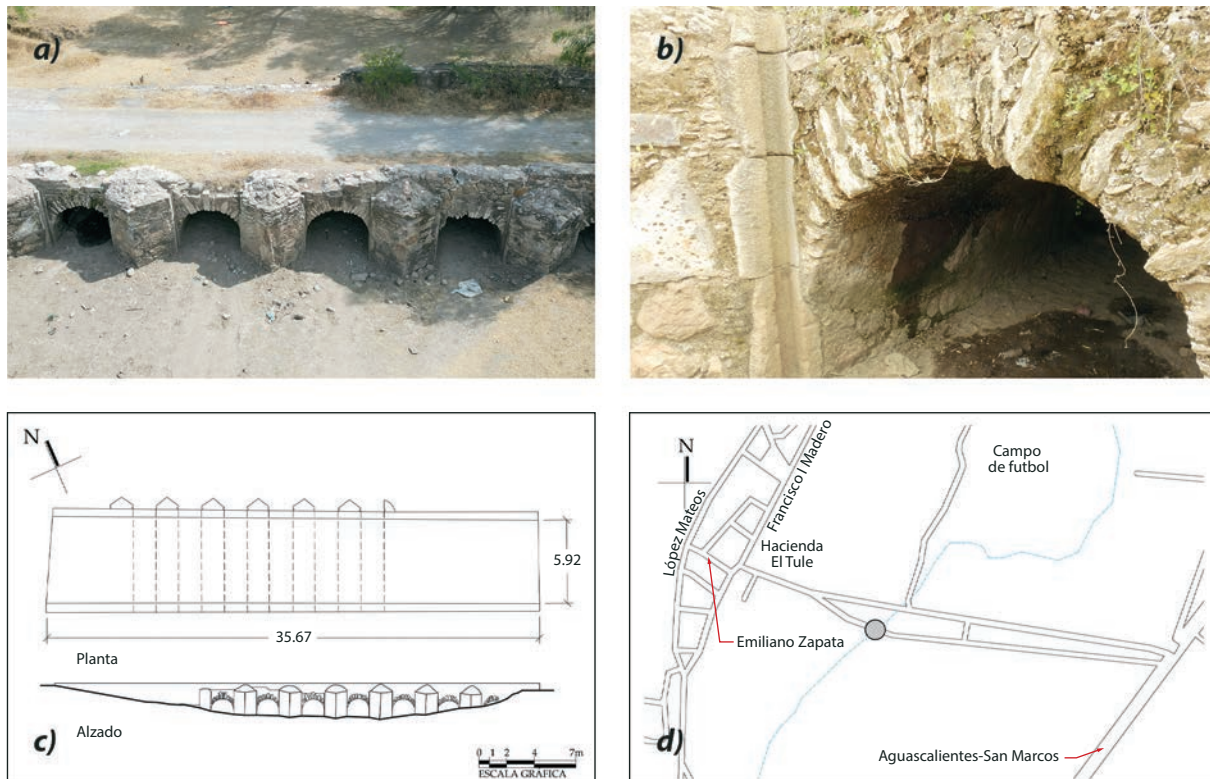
a) alzado norte, b) detalles constructivos de baranda y tajamar, c) croquis arquitectónico y d) croquis de localización del puente El Tule.
